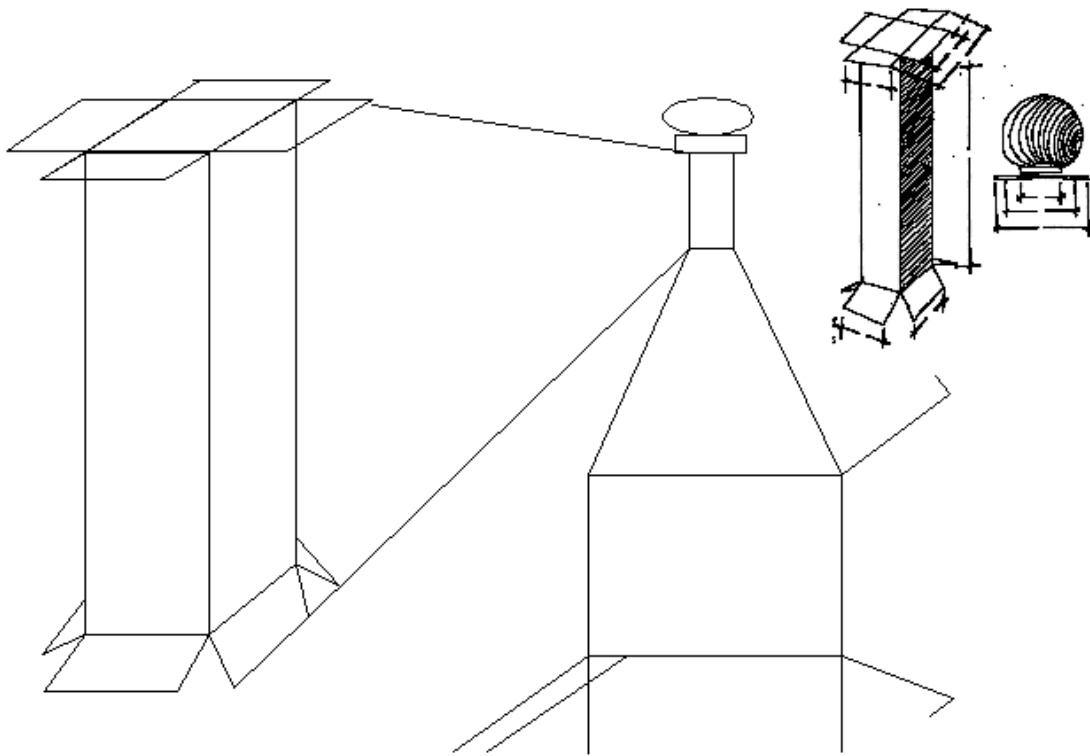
Croquis del equipo, Extractor atmosférico y tiro.
